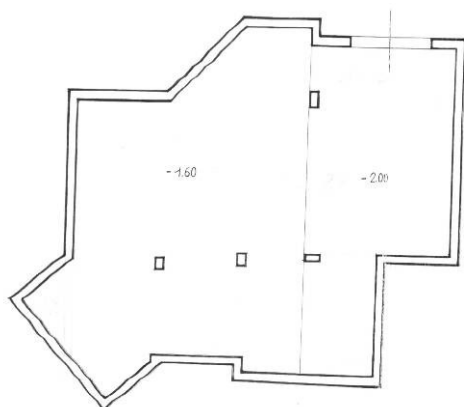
planimetria urbanistica del piano seminterrato della villa secondo la C.E. in sanatoria n.82/1993
